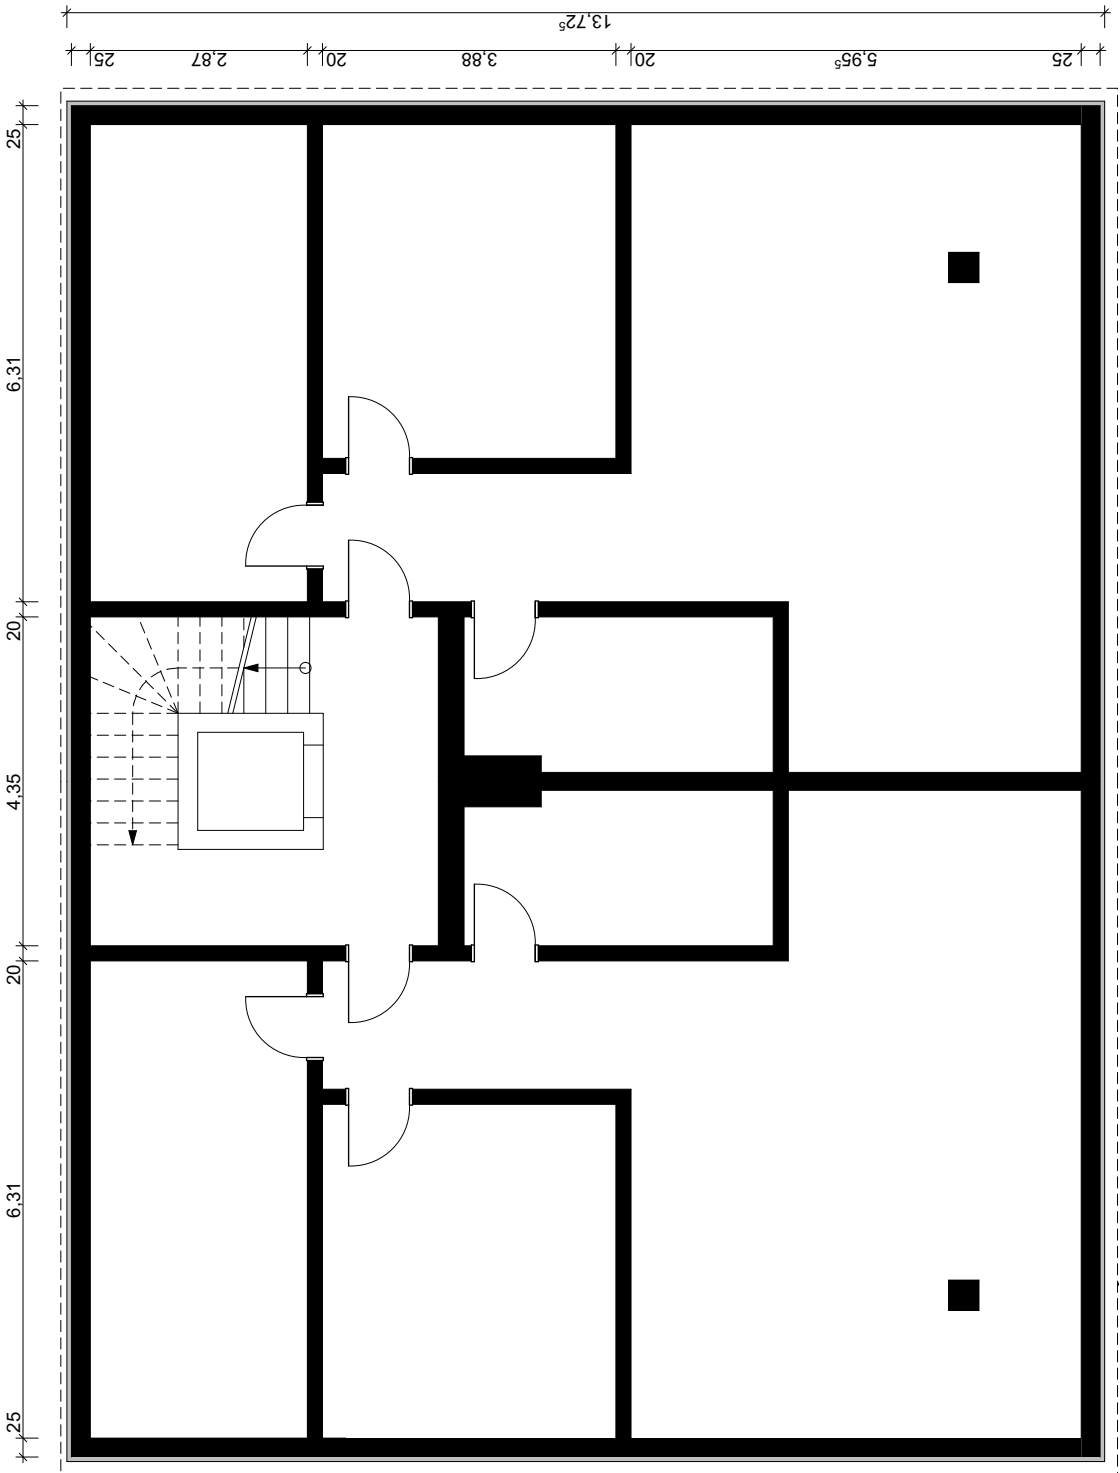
Grundriss Kellergeschoss M1 1:100
